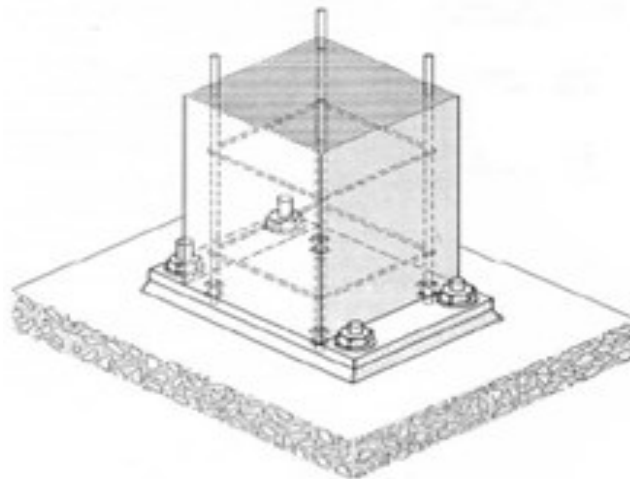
Modelo de ligação sapata-pilar através de chapa (STUPRÉ, 1981).
